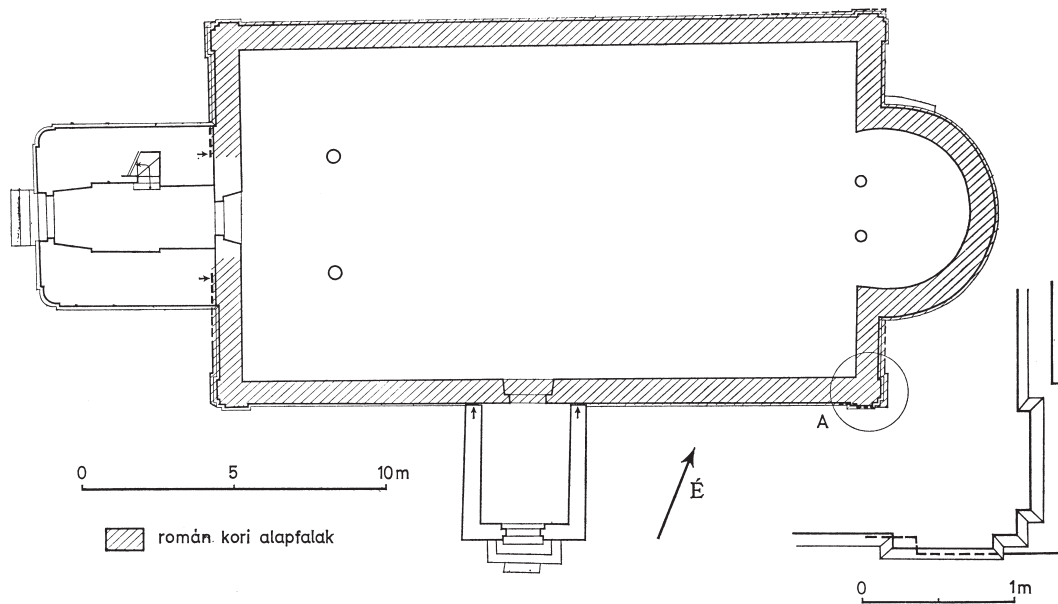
Biharugra (H): Calvinistische Kirche, Grundriss. Klassizistischer Bau mit möglichen früheren Details. – (Nach MRT 6, 25 Abb. 1).
